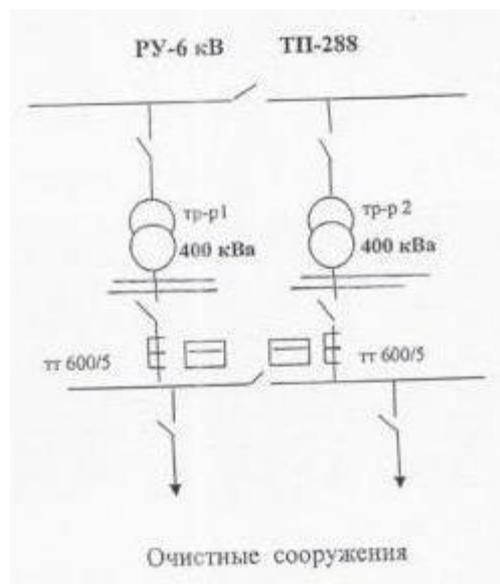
Схема электроснабжения КОС п.Крюково
